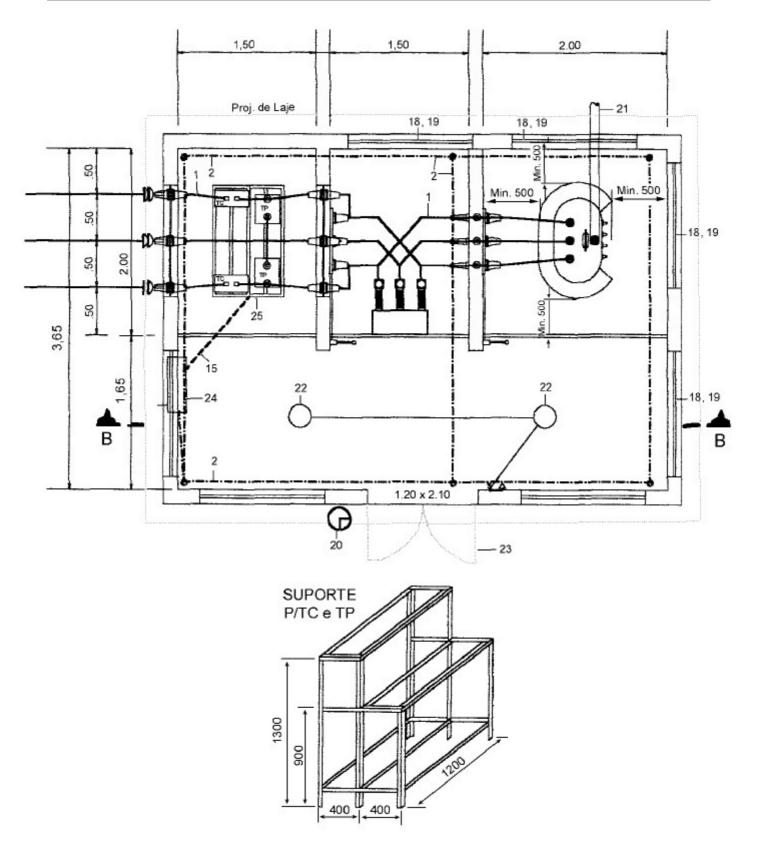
Subestação Transformadora Abrigada, Entrada Aérea Medição em AT – PLANTA BAIXA
